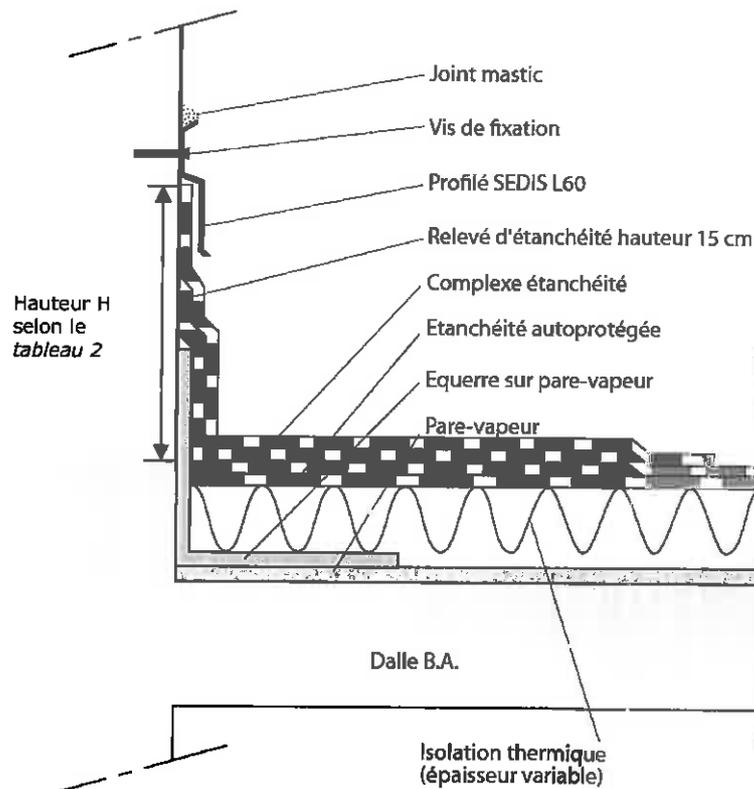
Toiture inaccessible à pente nulle sur maçonnerie
